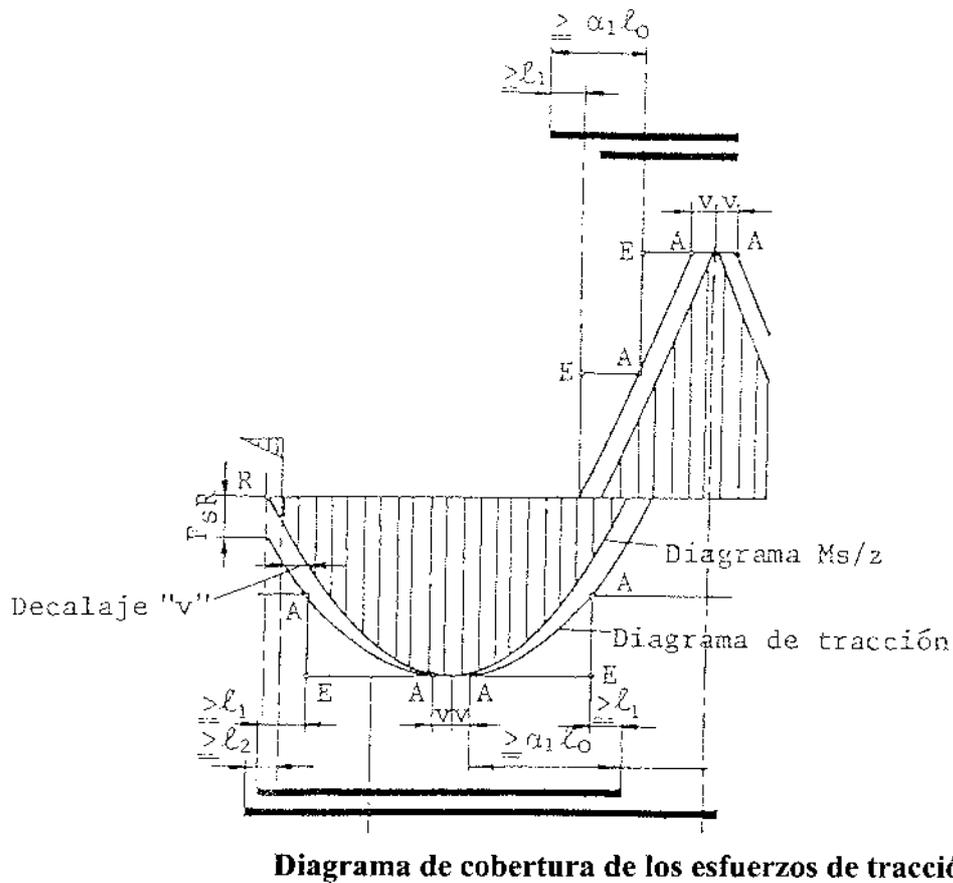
Ejemplo de una armadura escalonada en losas armadas con barras de $d_s < 16$ mm o alambres de $d_s < 12$ mm.
